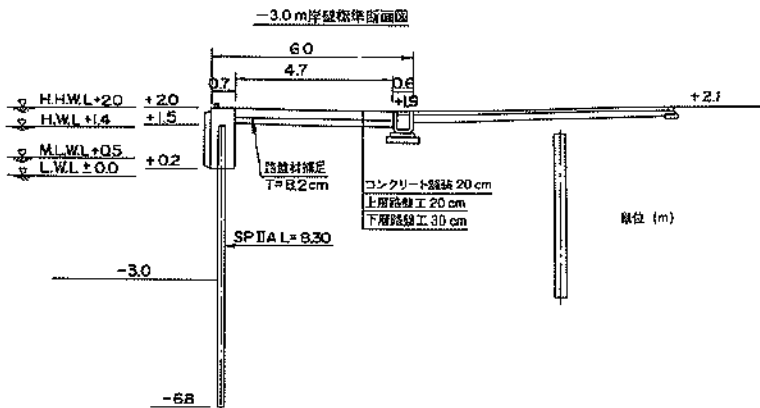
標準断面図 (長万部漁港、①-3.0m 岸壁)
